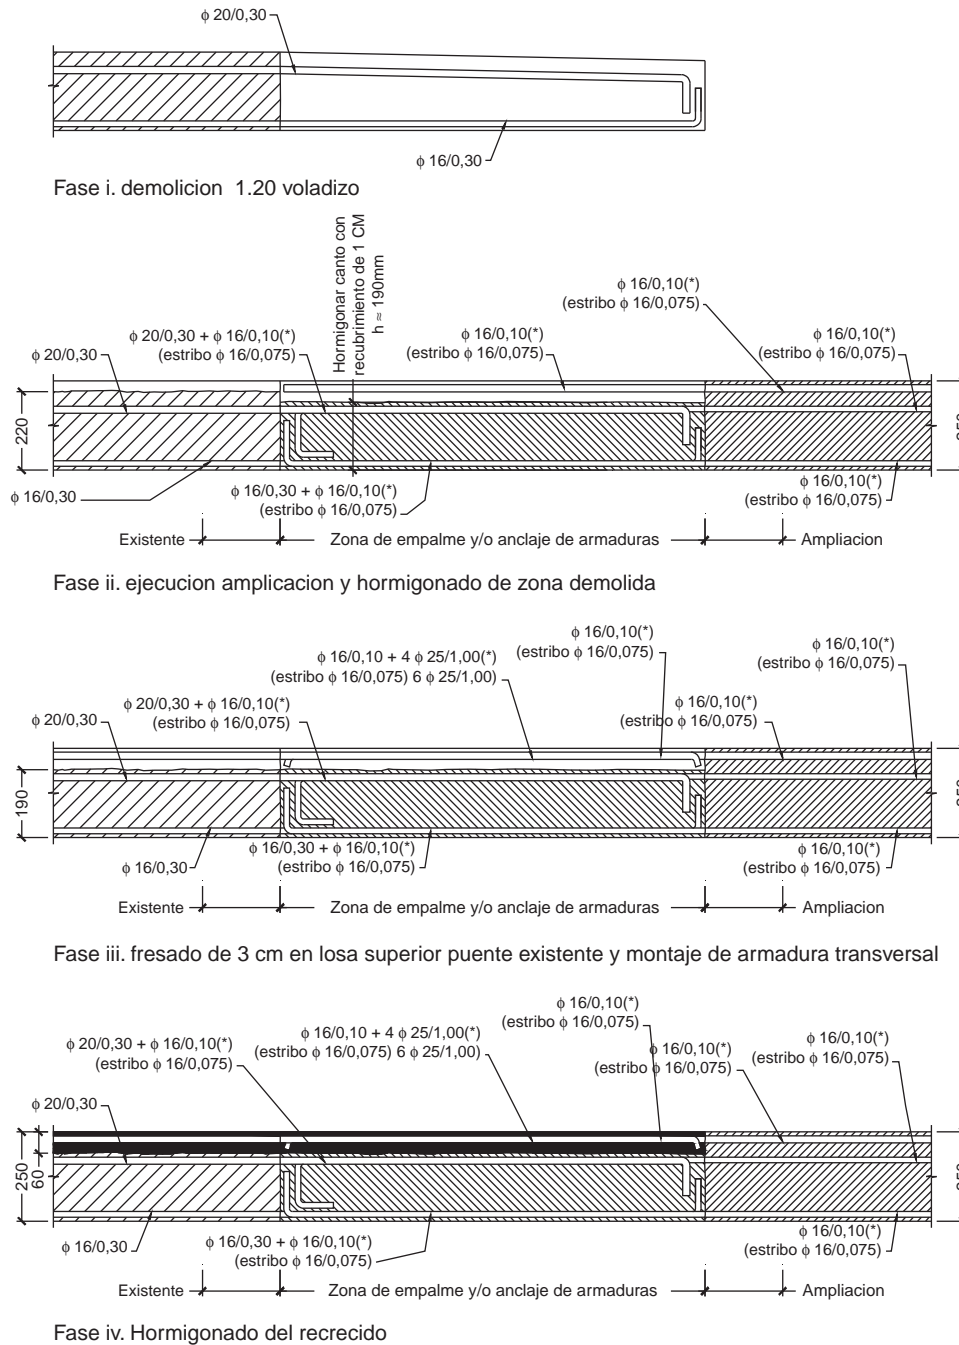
Fases constructivas y disposición de armadura para la conexión entre la losa existente y la nueva losa.
